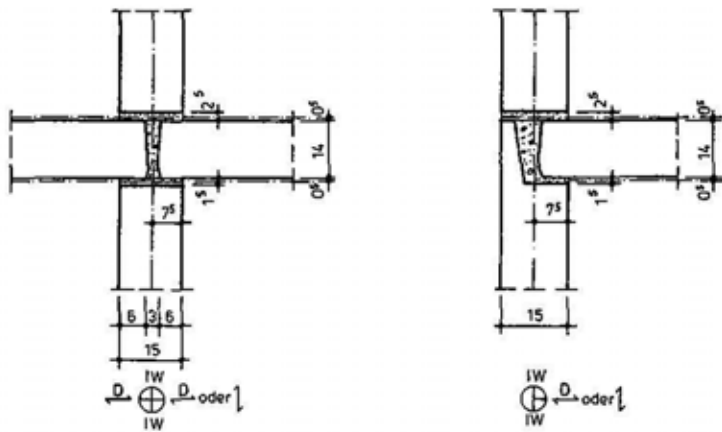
Horizontale Knotenpunkte Innenwand - Decke
